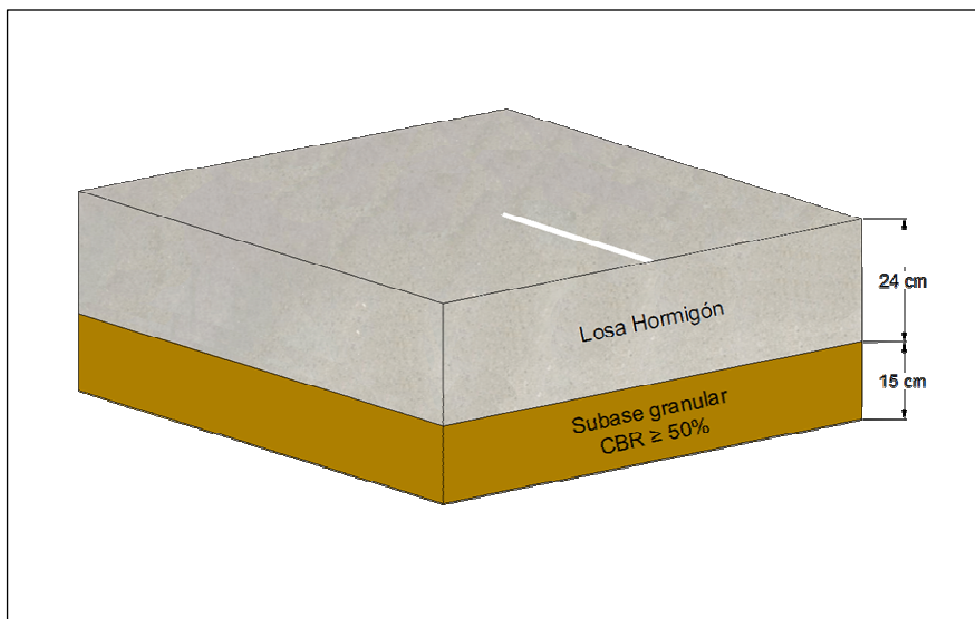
Esquema de la estructura de pavimento de hormigón construida para losas sin sistema de traspaso de carga según método AASHTO.
